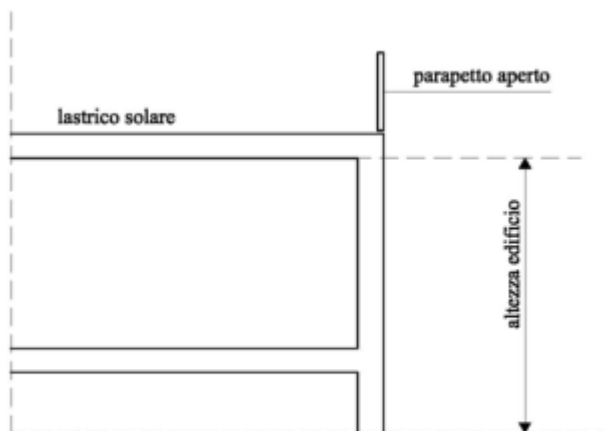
edificio con copertura, piana parapetto aperto e lastrico solare
